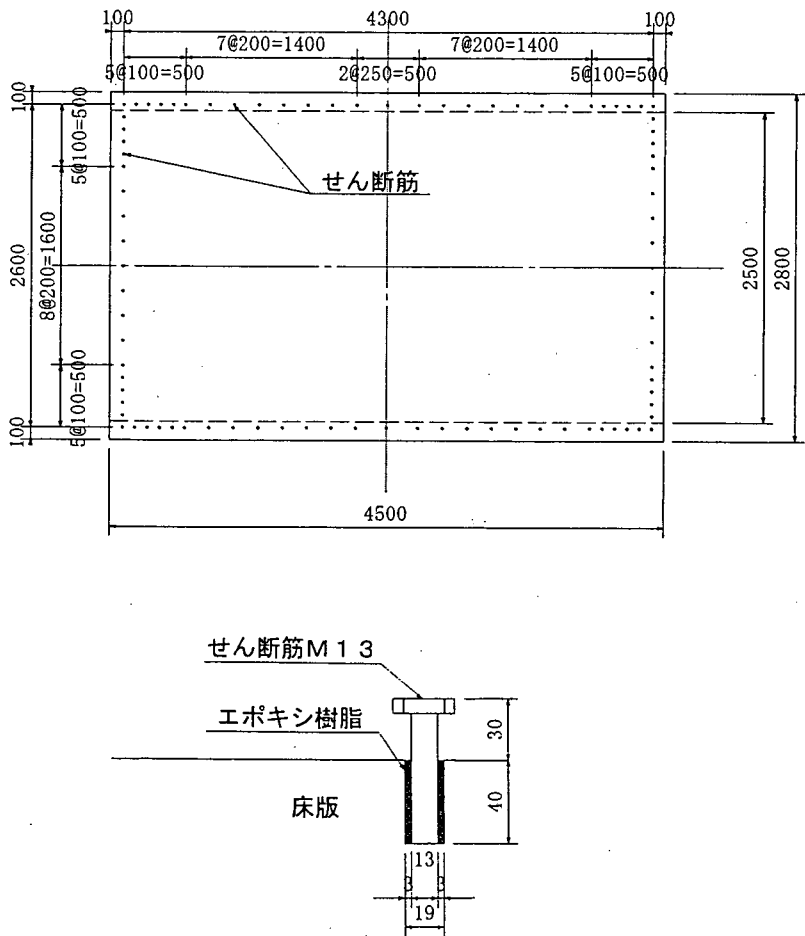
RC39+上面-2 供試体のせん断筋配置図 (単位：mm)
